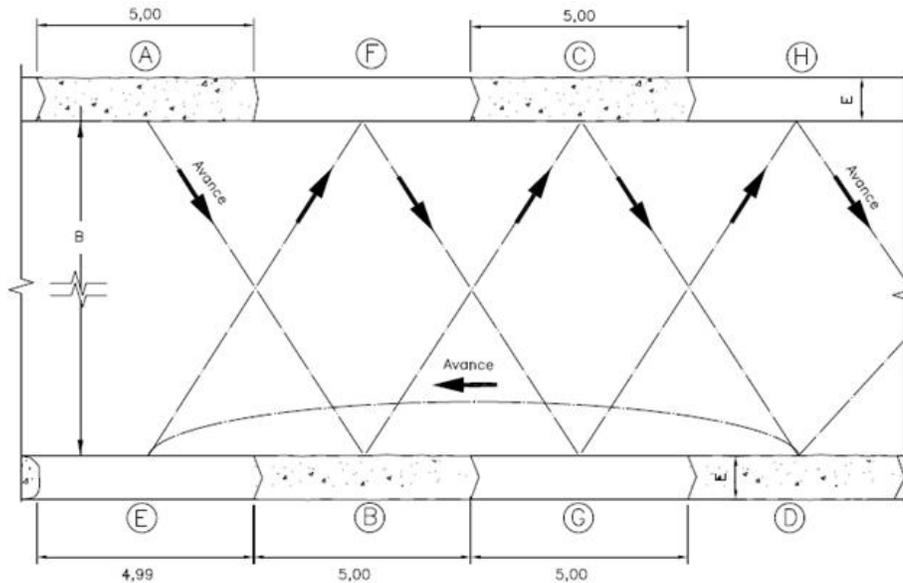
Secuencia de construcción de las pantallas preexcavadas (planta)
